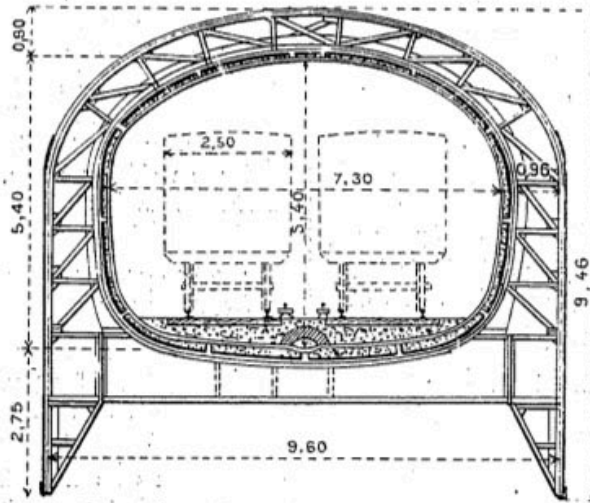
Coupe en travers d'un caisson immergé sous la Seine.
